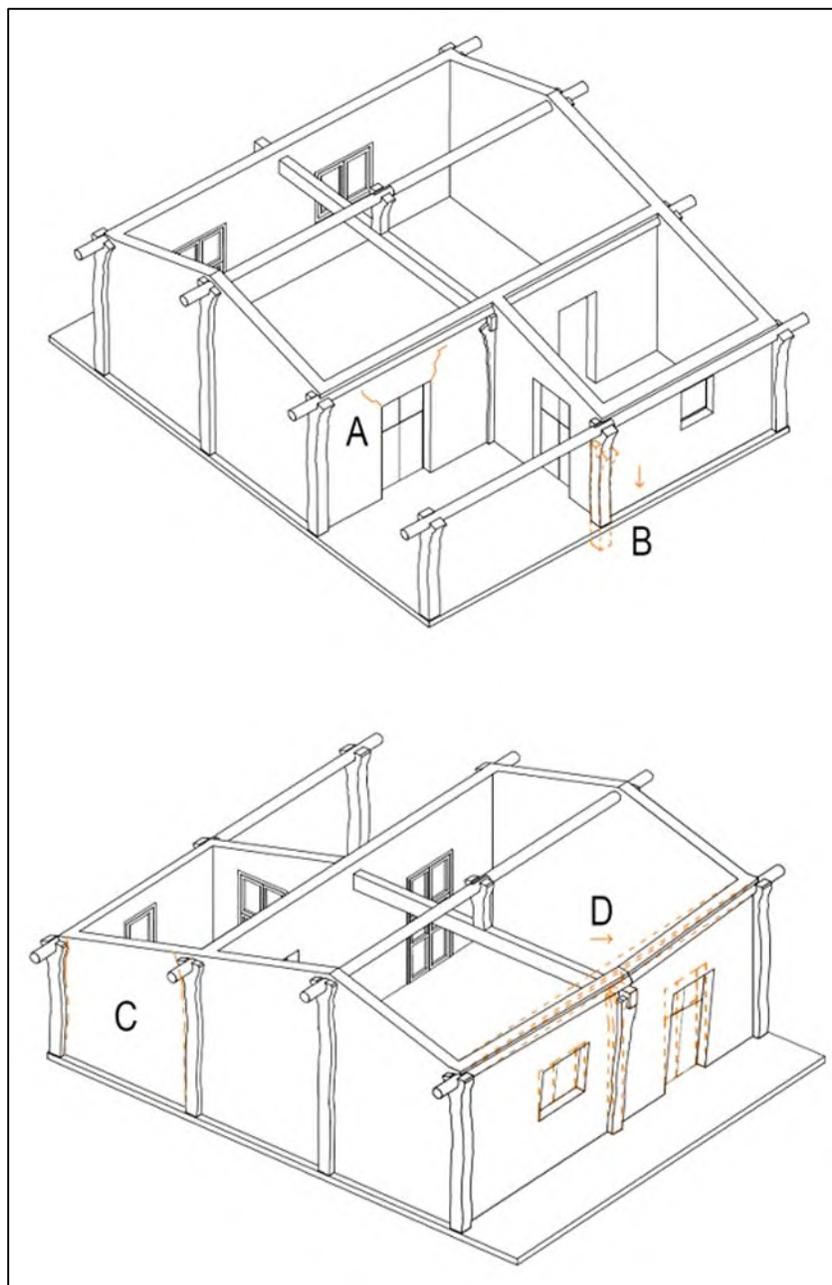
Daños mayores en la vivienda de bajareque de La Blanca, Sto. Domingo Ingenio: A) agrietamiento de vértices de puertas y ventanas B) hundimiento de pilares, C) Separación entre los muros y pilares y D) desplome de muros y pilares. Fuente: elaboración propia.
